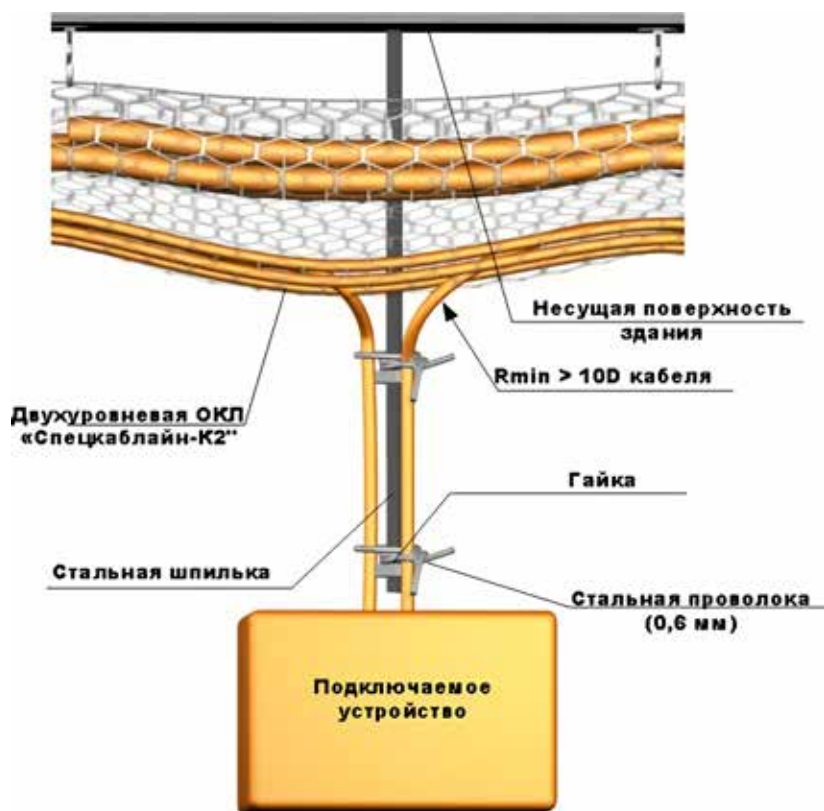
Спуск кабеля к устройствам на подвесном потолке
